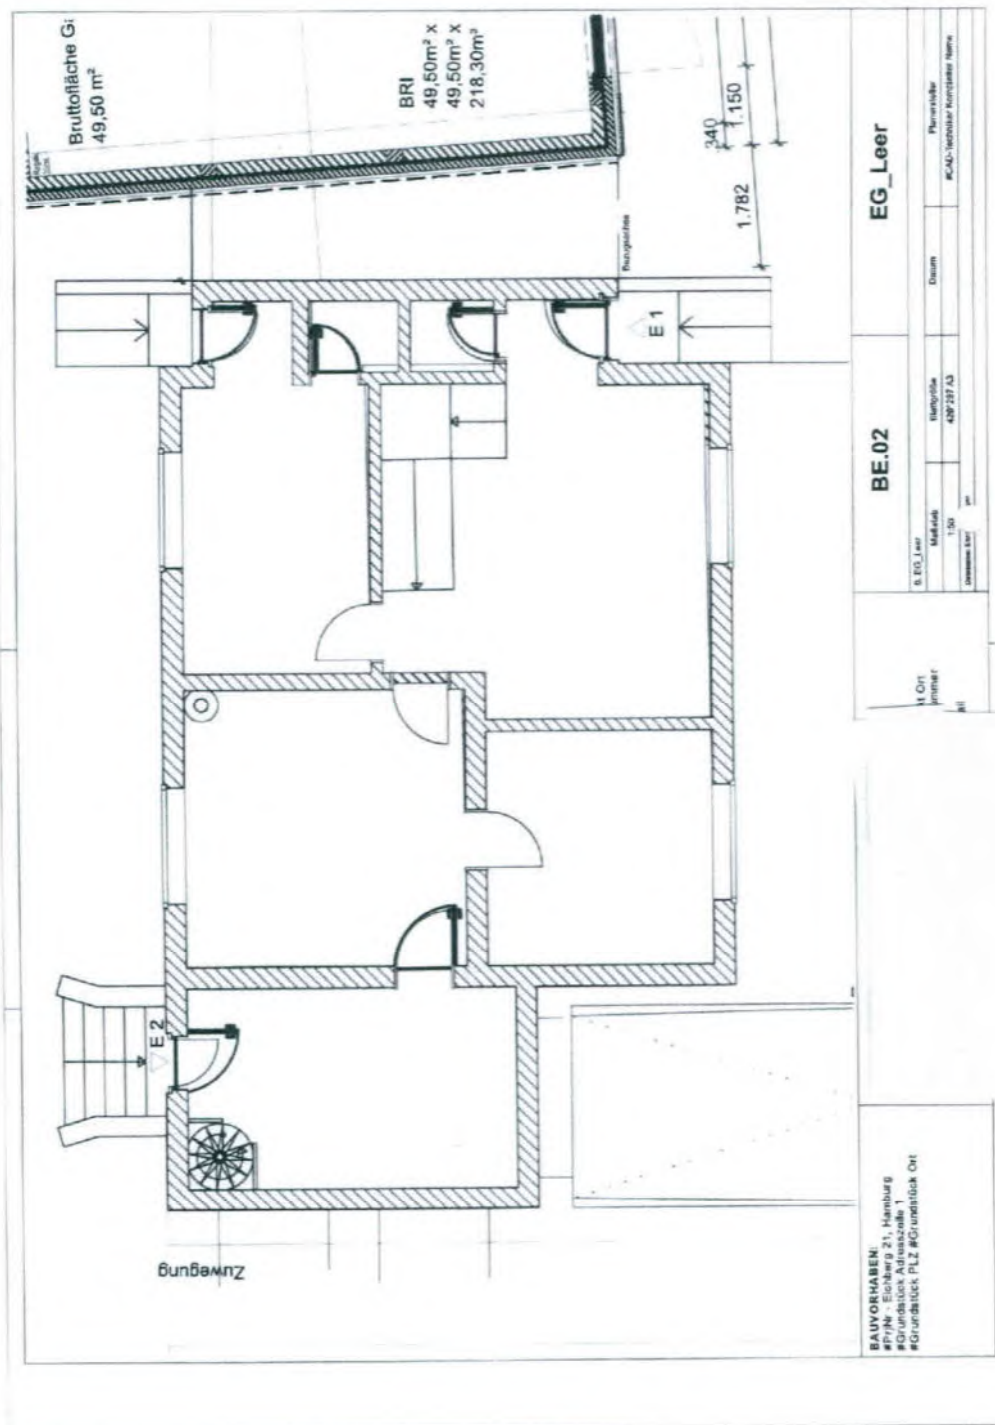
Grundriss EG (mit Garagengebäude) 2011
